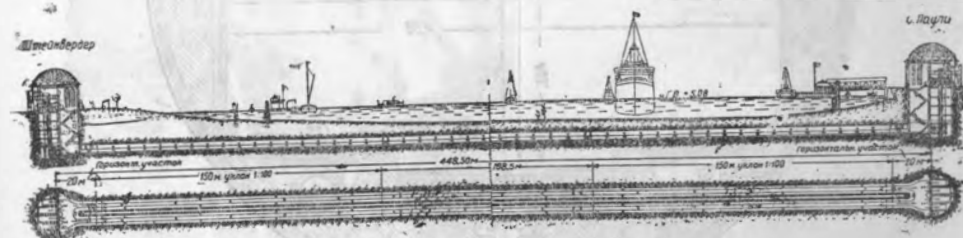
План и разрез подводного тоннеля под рекой Эльбой в Гамбурге.
